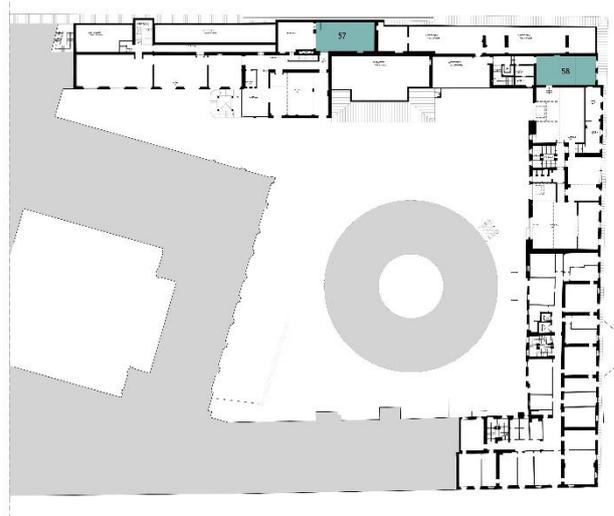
Pianta dello stato di fatto con indicazione dei locali riservati alla didattica, piano terra.
